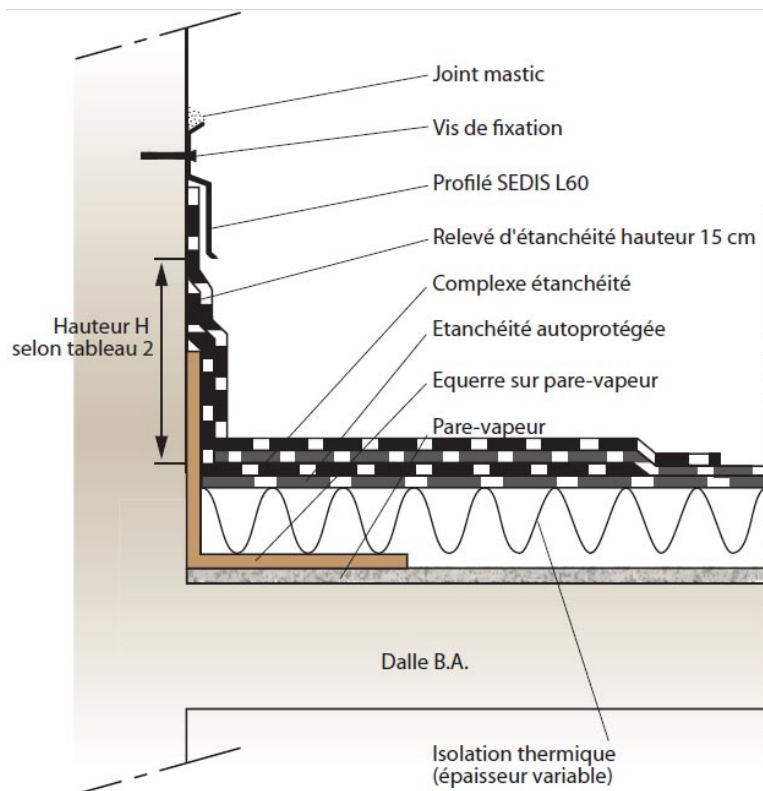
Toiture inaccessible à pente nulle sur maçonnerie
